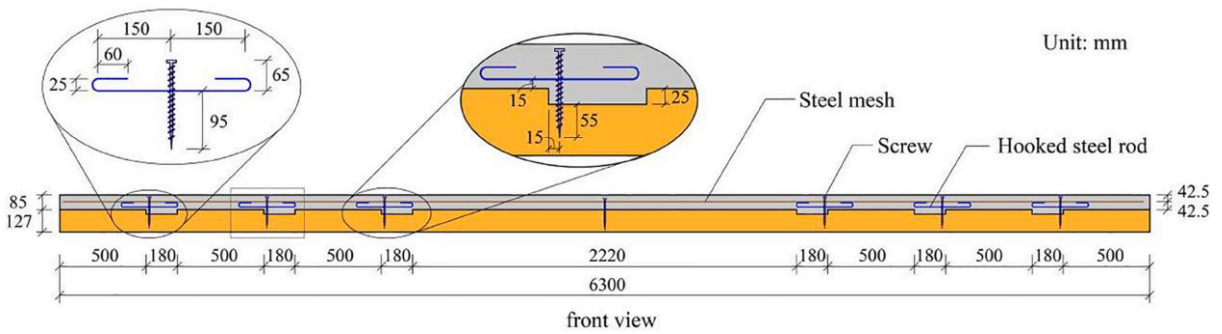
La méthode de renforcement de la poutre mixte en Bois -béton proposé par Zhang et al. [37]
